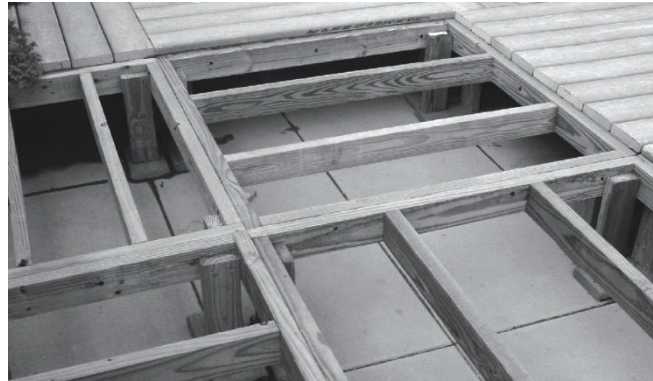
Base estructural para deck de madera. Tomado de (Arquitectura, 2014)
